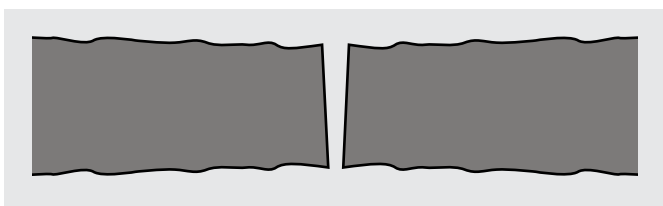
dalles pressées à sec avec bords pressés non retouchés.
